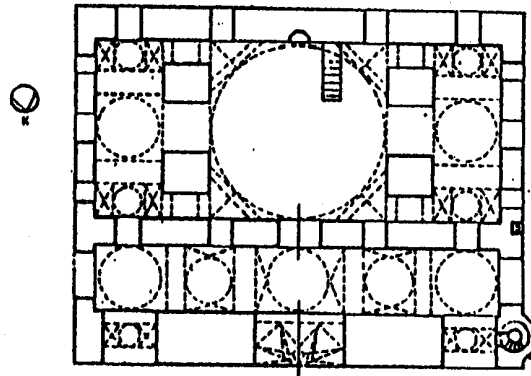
مسقط أفقي لجامع رستم باشا في استانبول
